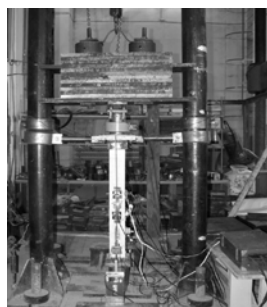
Копровая установка со стендом, подготовленным для динамического испытания железобетонного элемента работающего на сжатие, масса испытательного груза 0,385 Т.
